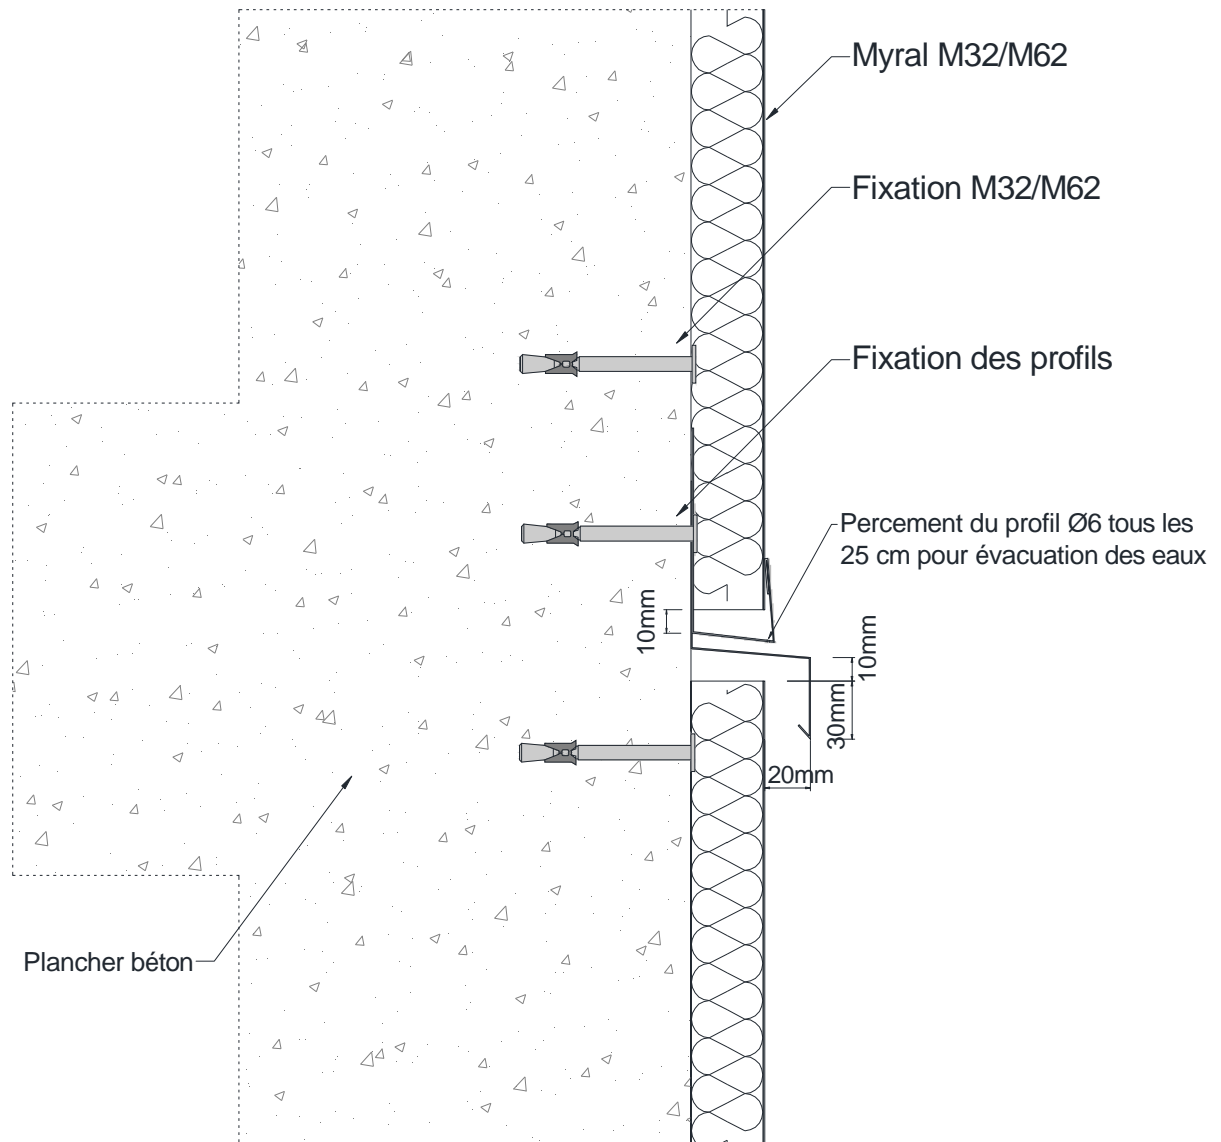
Fractionnement de la vêtture/vêtage au droit de chaque plancher sur béton
